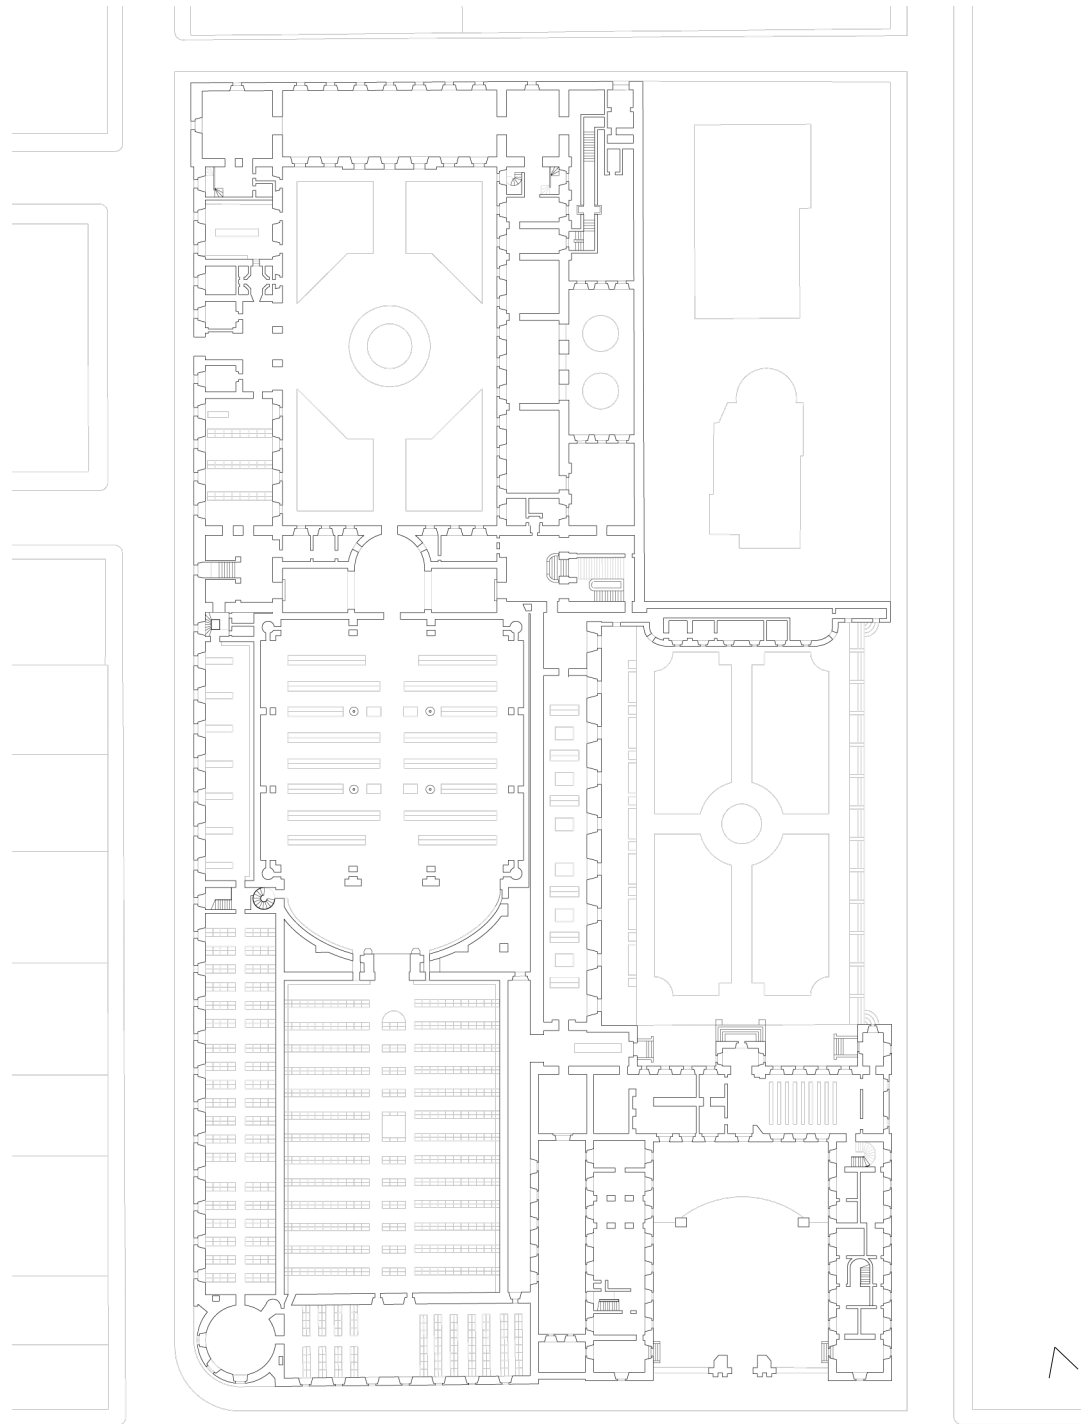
Bibliothèque nationale ground floor plan, 1:1000
